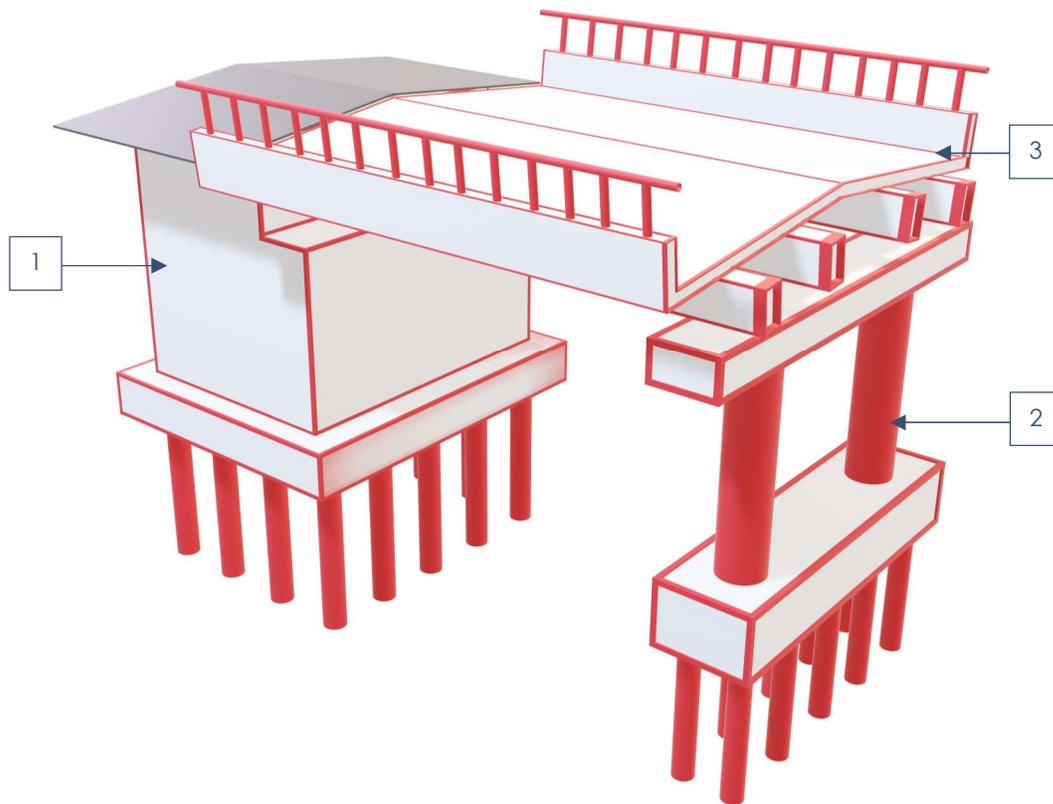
En el esquema IFC BRIDGE, actualmente en proceso de revisión, la entidad general muro puede especificarse directamente según el listado de los tipos más utilizados (TypeEnum), pues en esta versión se incorpora el tipo de muro de CONTENCIÓN.
